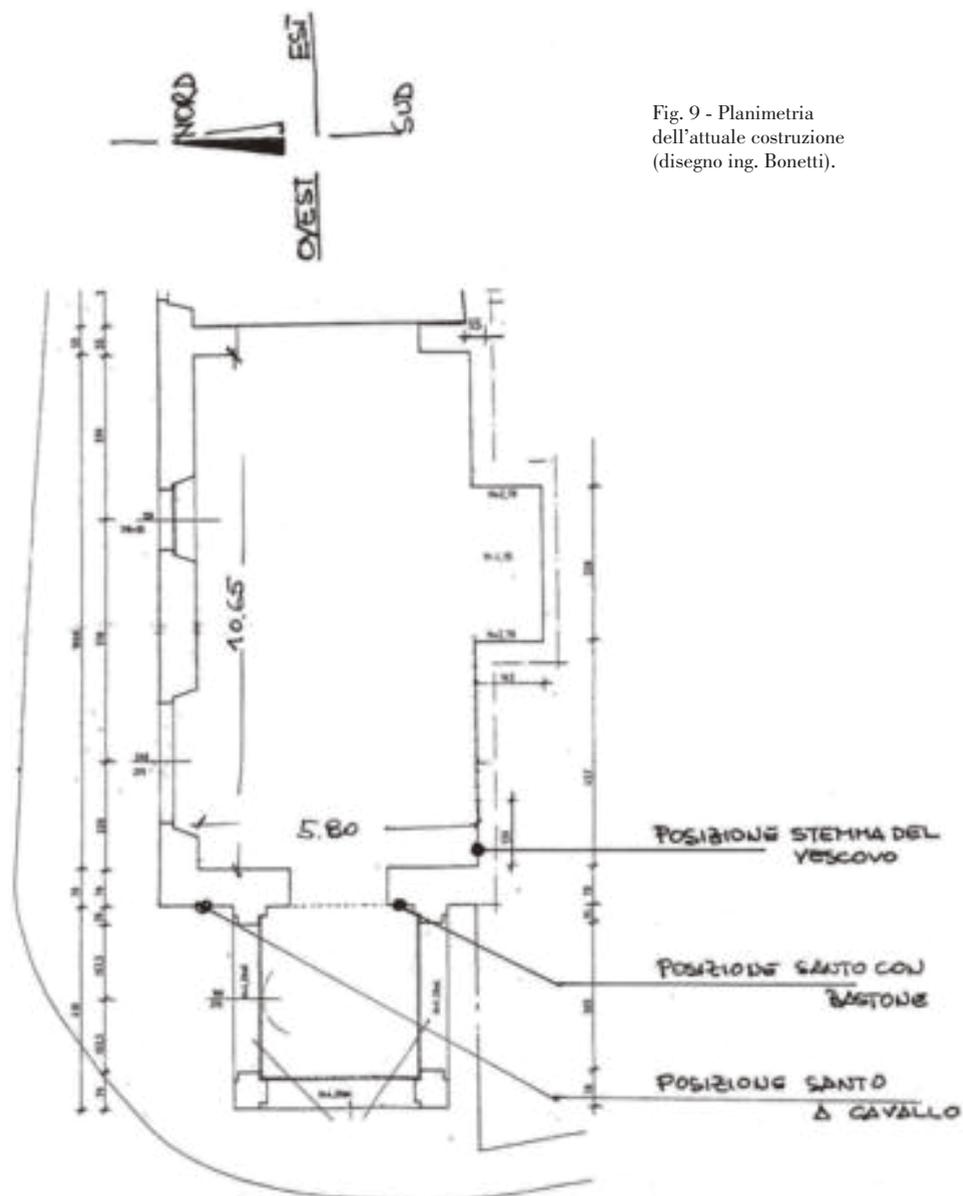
Planimetria dell'attuale costruzione (disegno ing. Bonetti).
